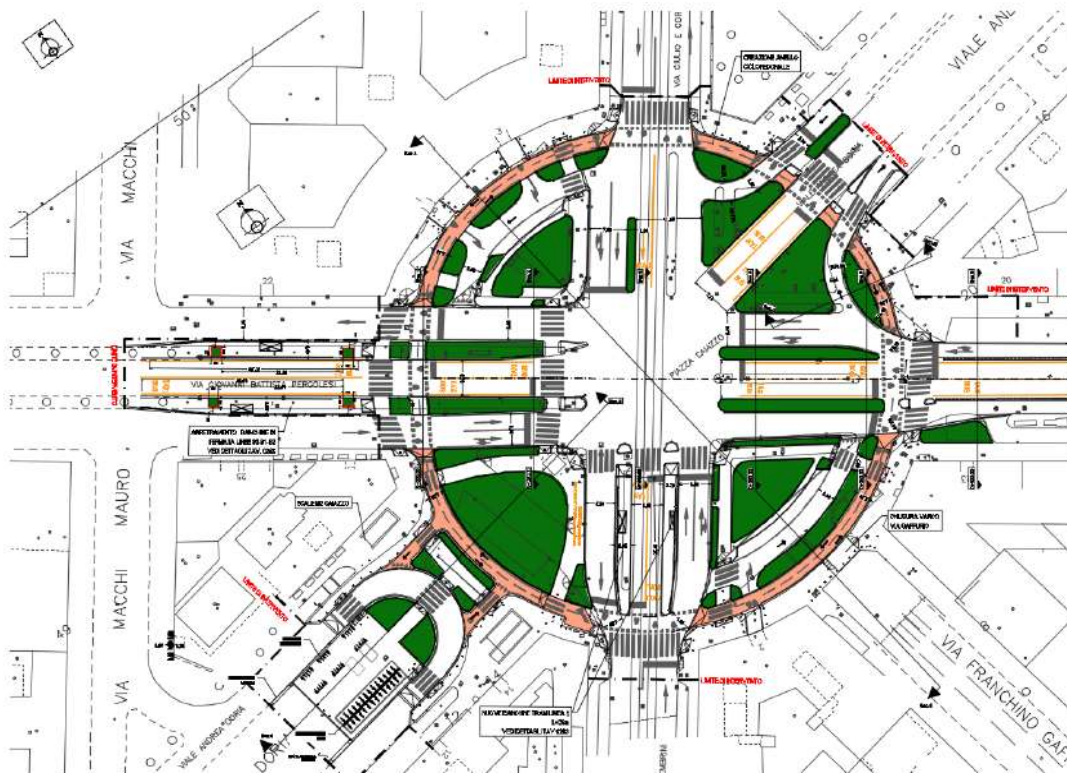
planimetria di progetto della viabilità in piazza caiazzo
